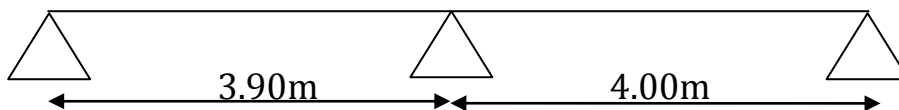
Schéma statique de la poutrelle Simply appuyé.
